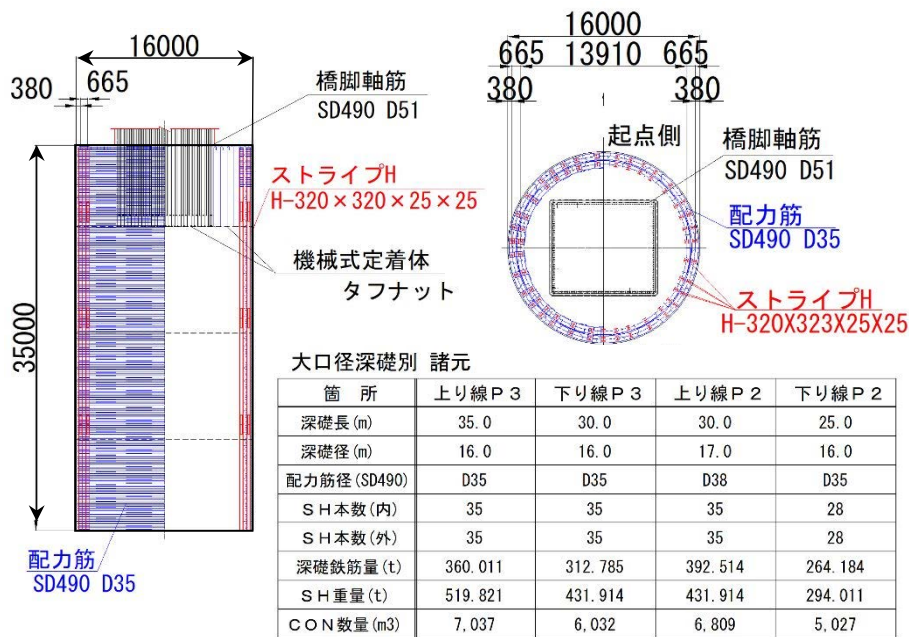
大口径深礎構造概要図 (平面・断面図は上り線 P3 を例示)
